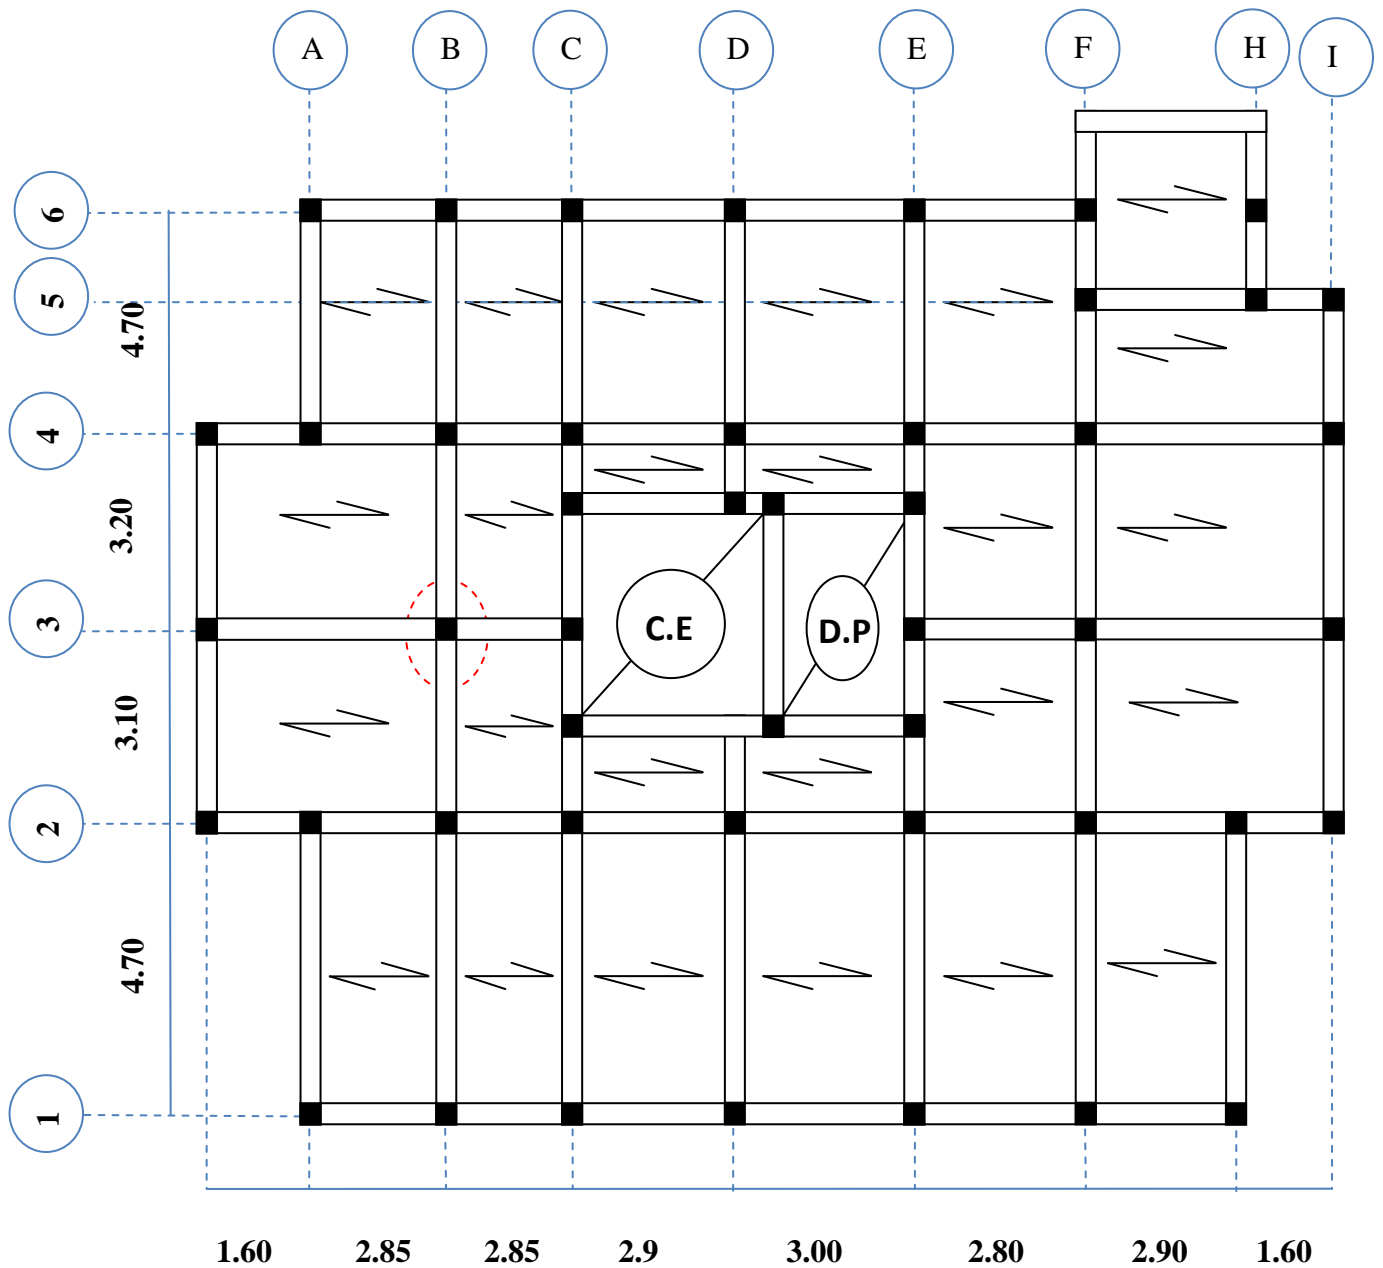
Disposition des poutrelles RDC+Entre sol 1 +étage courant
